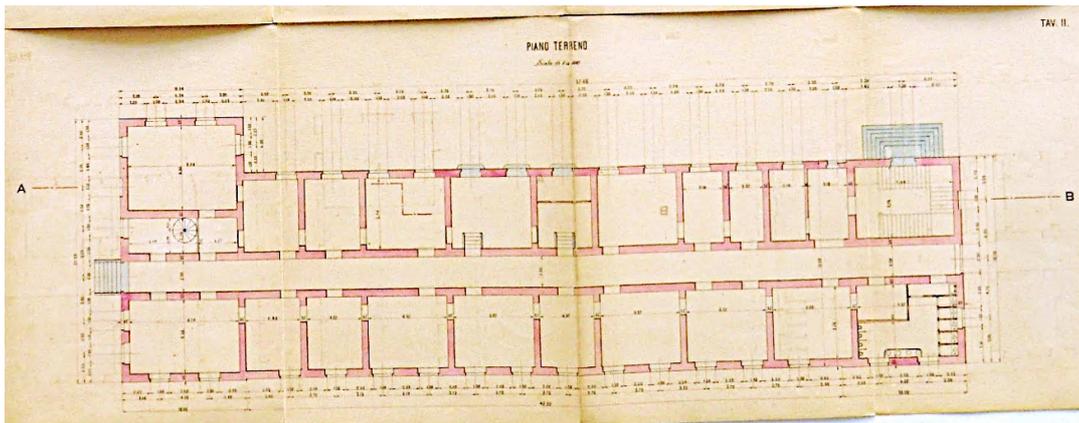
Pianta pianoterreno edificio Direzione su Via Acquasanta, 1898 (Archivio Fincantieri Palermo)
